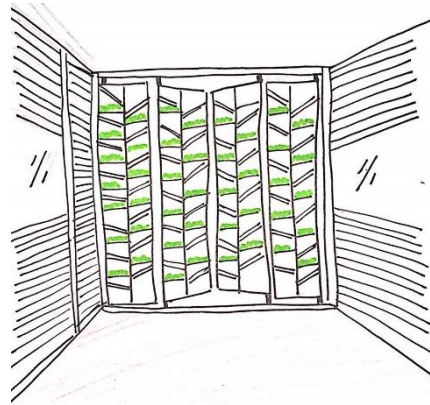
Konsep Penggunaan Material Lokal Ekologis Pada Fasad Bangunan 2 Lantai
